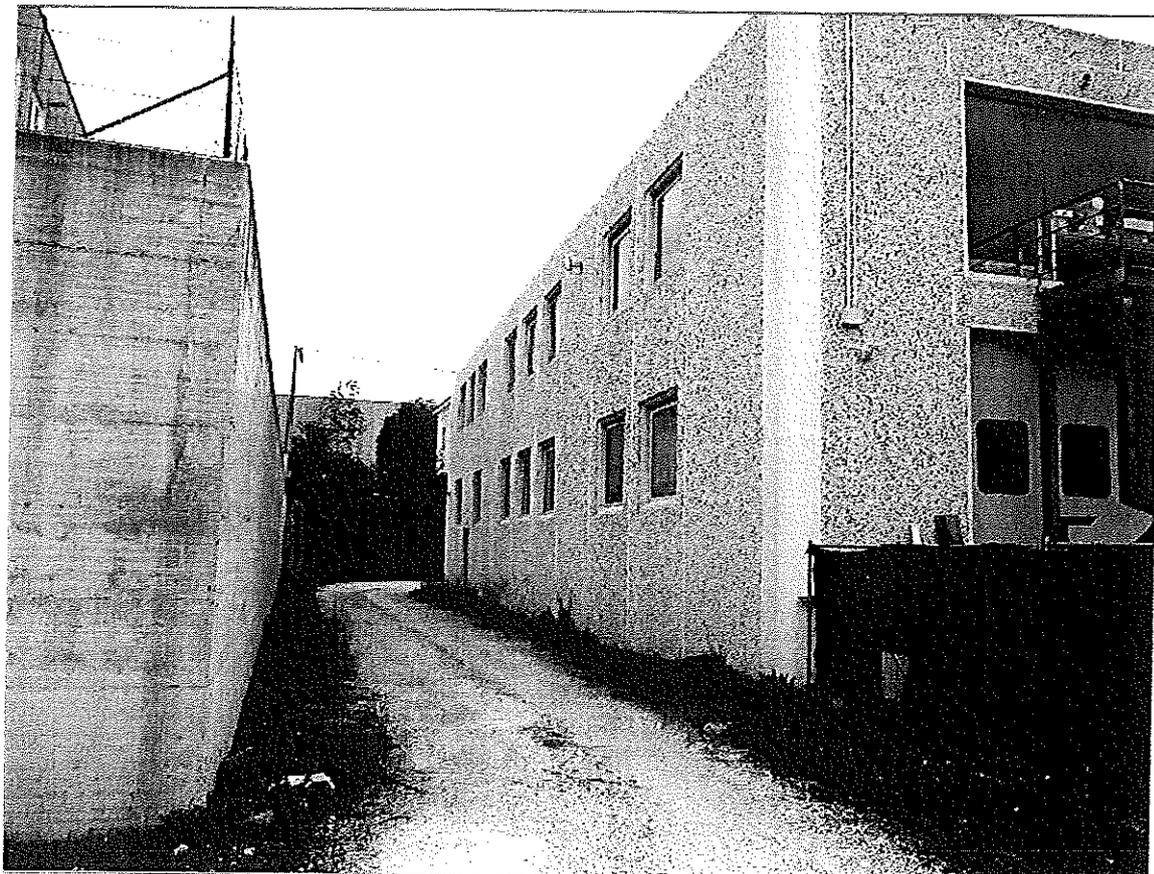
Opificio-- Parete Ovest -- ingresso al vano scala
